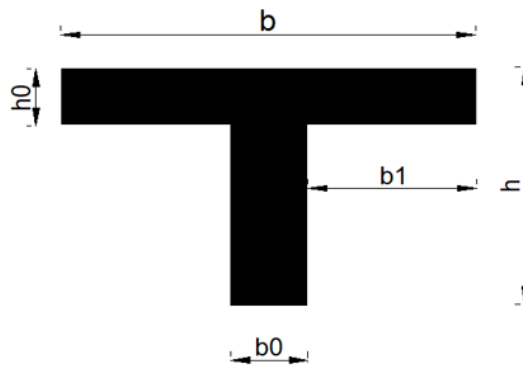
Pré-dimensionnement de la poutrelle
